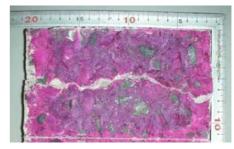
ひび割れ中性化深さ(case1-PL-5% 16 週)
